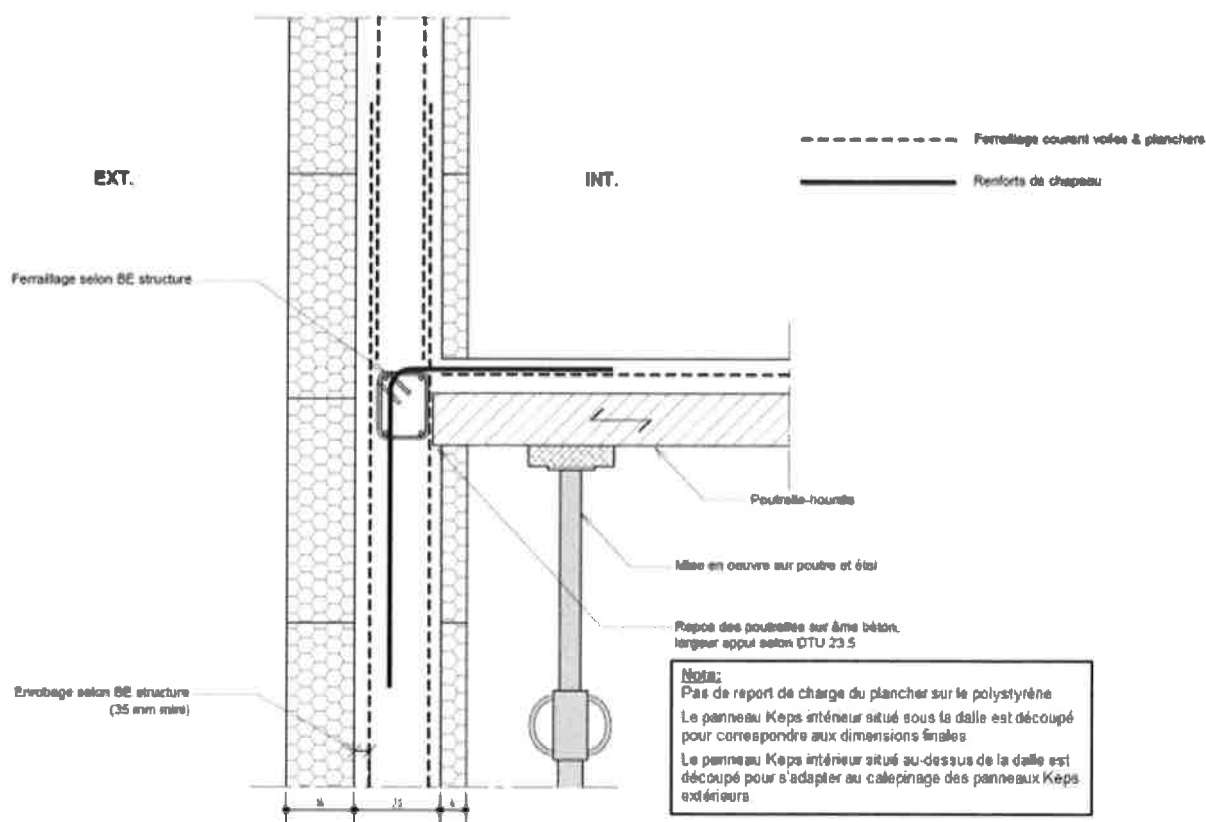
liaison mur-plancher à poutrelles (sens longitudinal)
